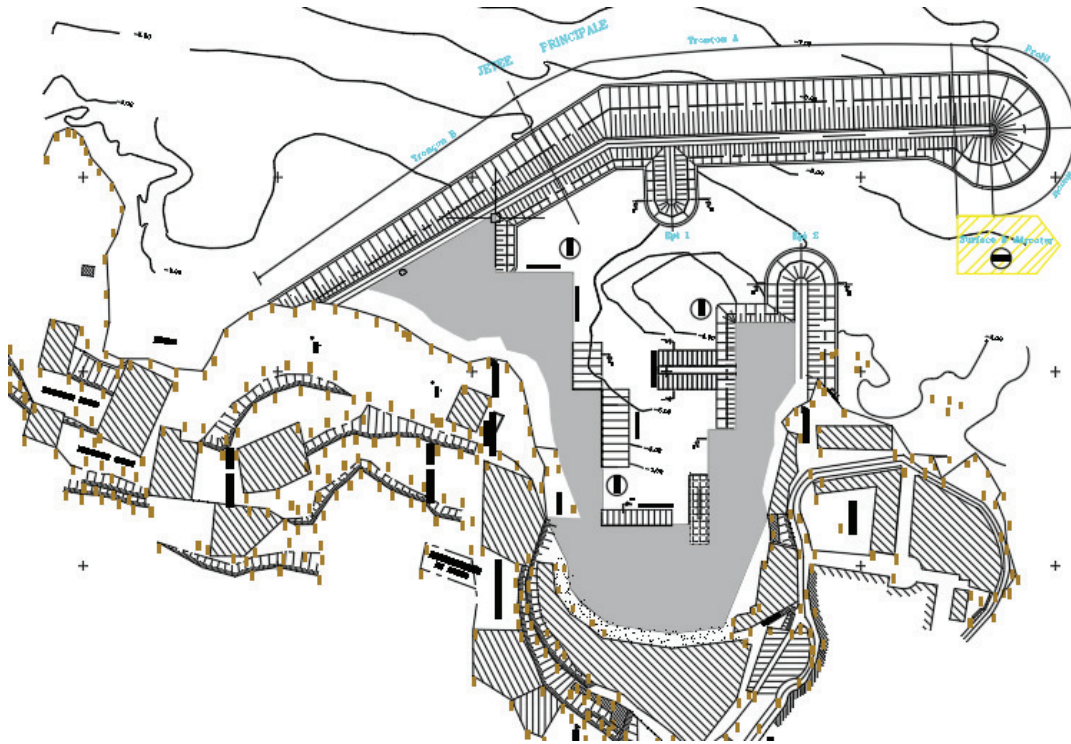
Plan de masse de la variante 2 d'aménagement
